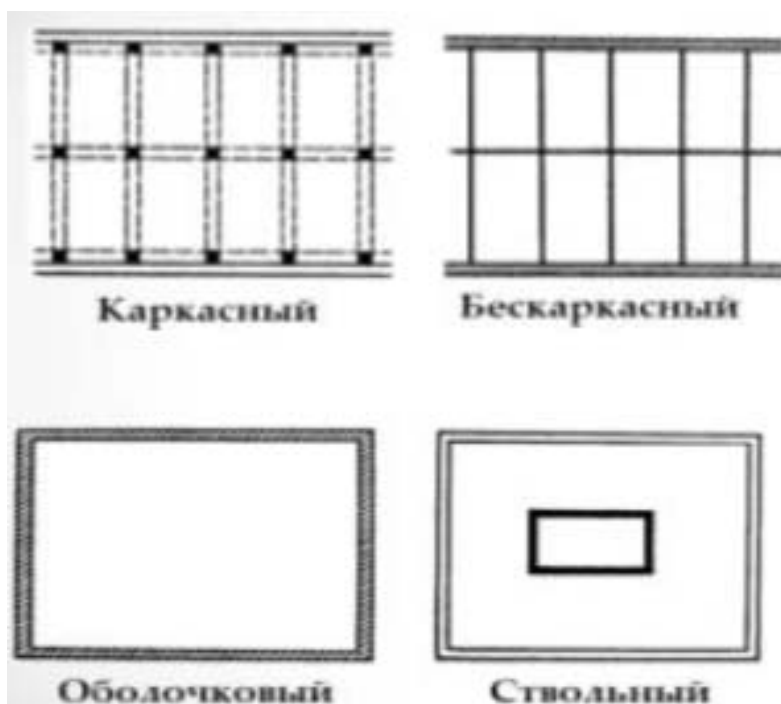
Конструктивные схемы высотных зданий: а) каркасная схема б) бескаркасная схема в) оболочковая схема г) ствольная схема.
